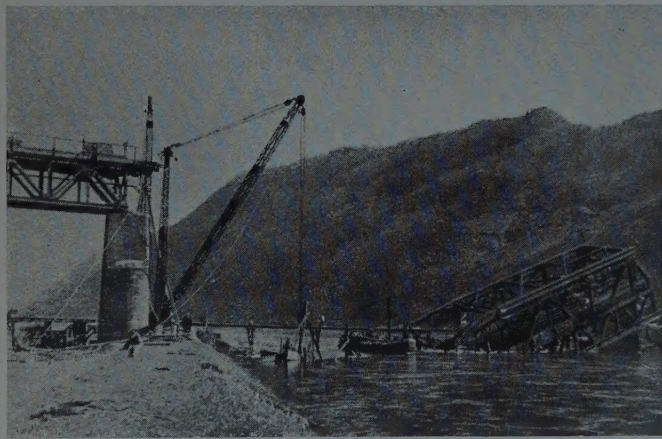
Pont d'Eller. Vue prise en cours de montage.
